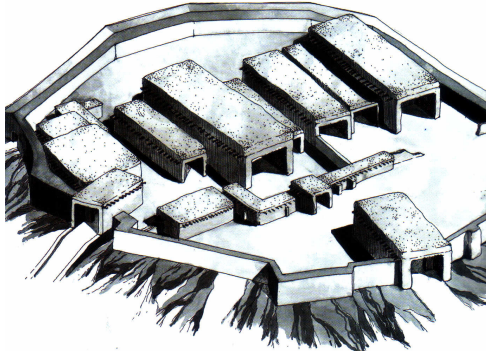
Genel yerleşim planı, Deir el Medineh (<http://oi.uchicago.edu/OI/IS/SANDERS>)
